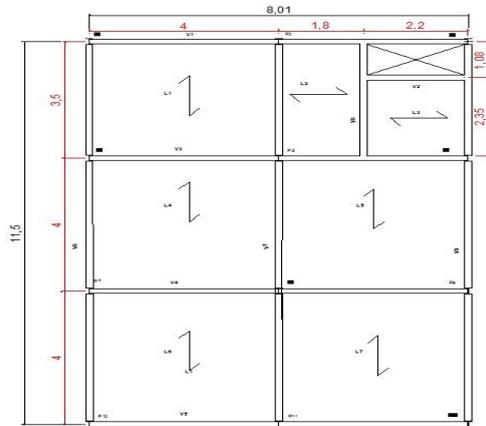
Planta baixa do piso de um prédio utilizada como exemplo neste estudo de caso.
